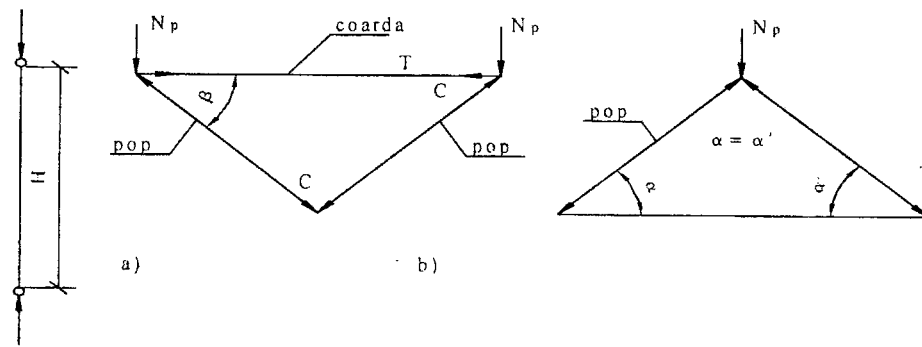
Stabilirea schemelor de calcul pentru popi
